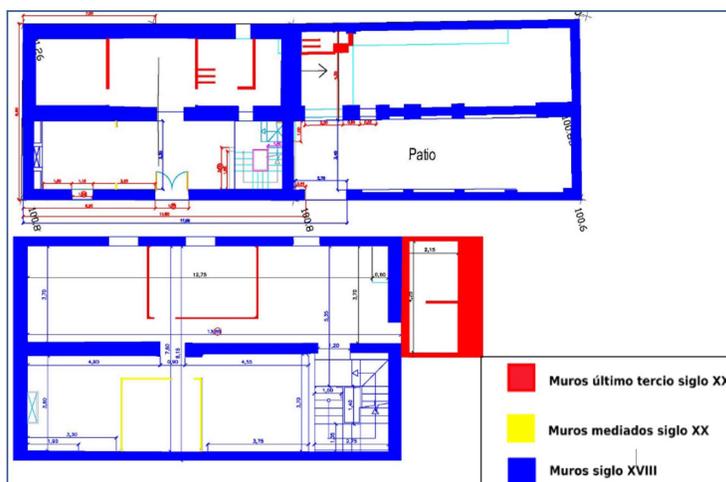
Planimetría donde se reflejan en varios colores las diferentes fases constructivas del inmueble. Planta baja en la parte superior y planta primera en la inferior.
